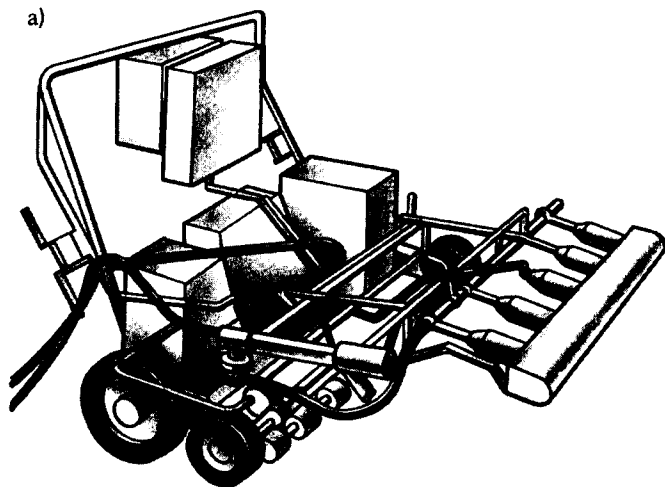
Принципиальная схема кровельной установки для укладки и наклейки наплавляемого рубероида безогневым способом
